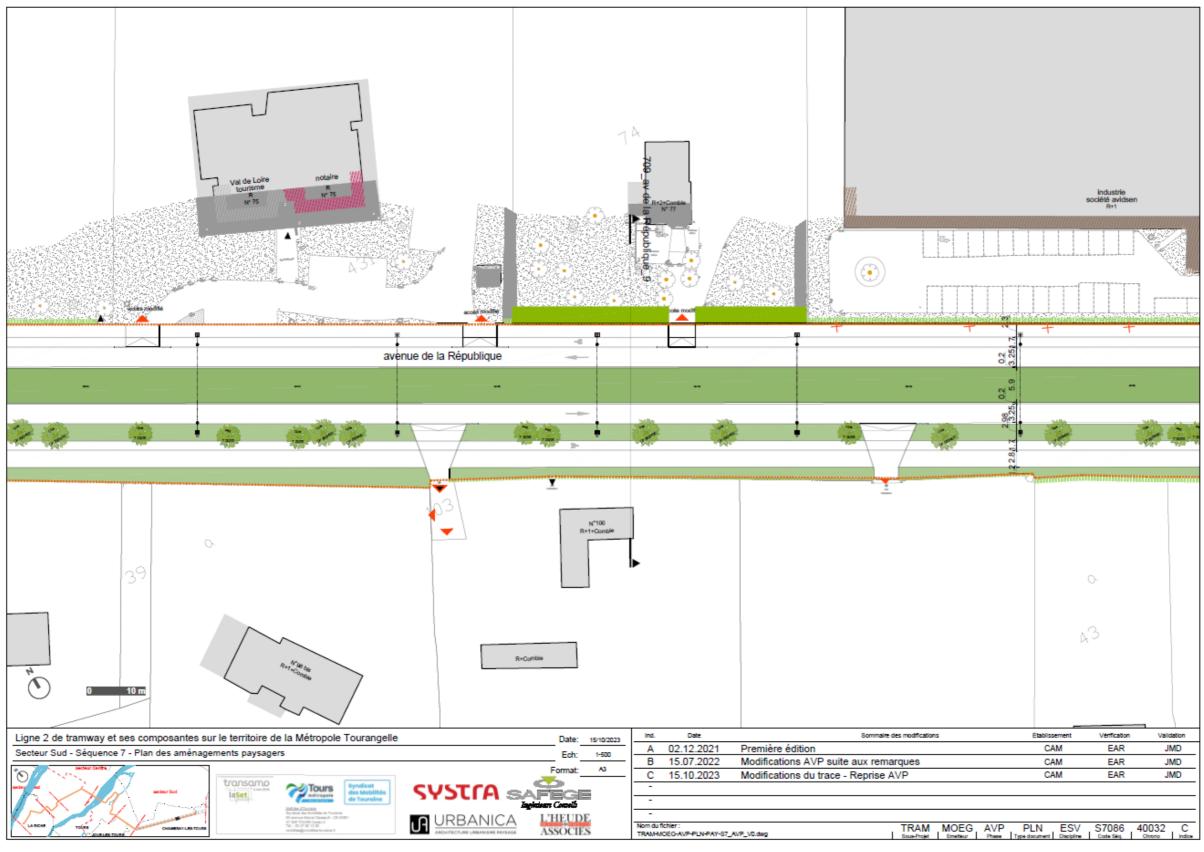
plan masse de localisation des arbres à abattre sur avenue de la République – Section 3 (planche 14)
